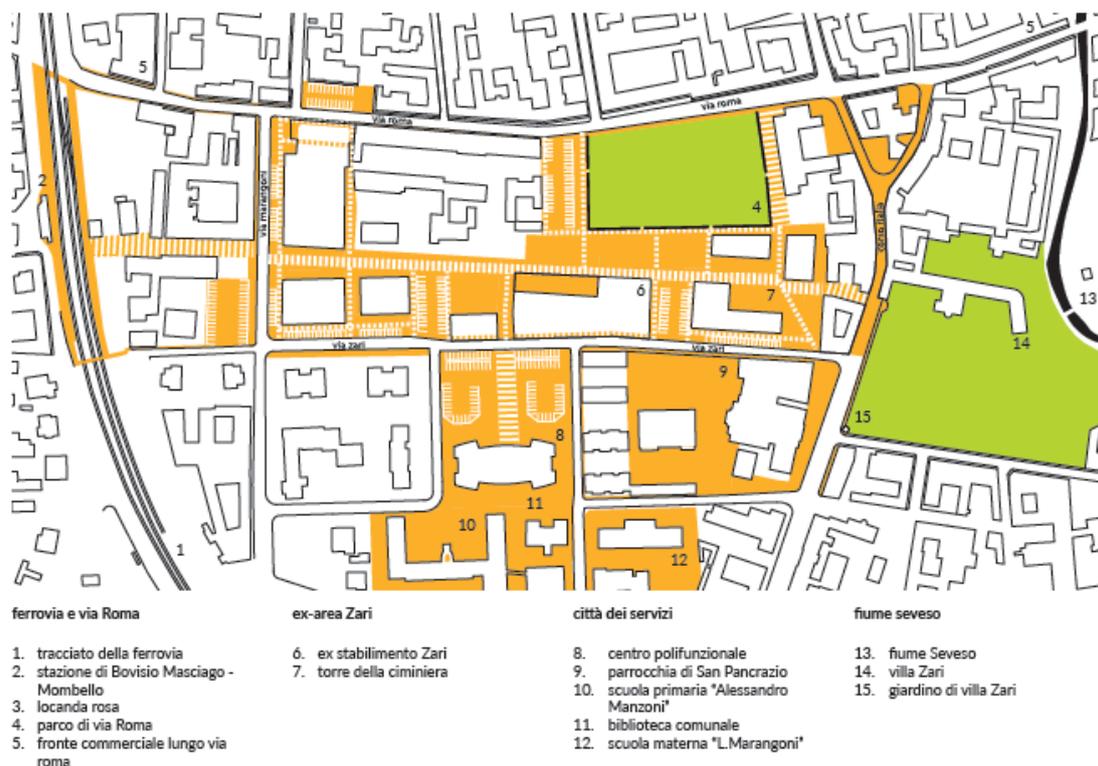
| Strategia 1: restituire spazio alla città, un progetto di connessioni di servizi dalla stazione al Seveso.
